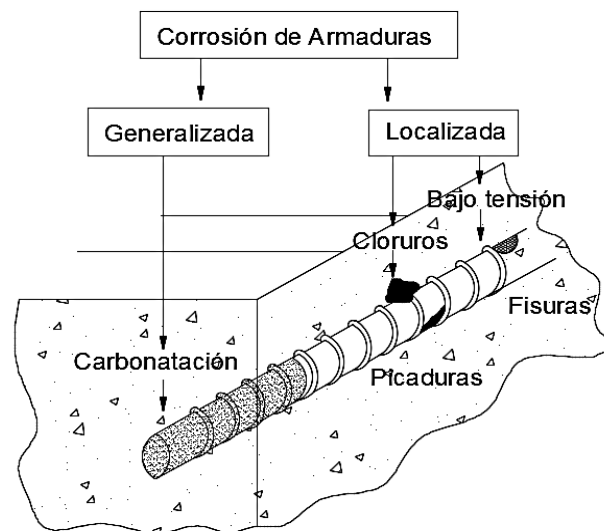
Tipos de corrosión habituales en armaduras en contacto con el concreto
